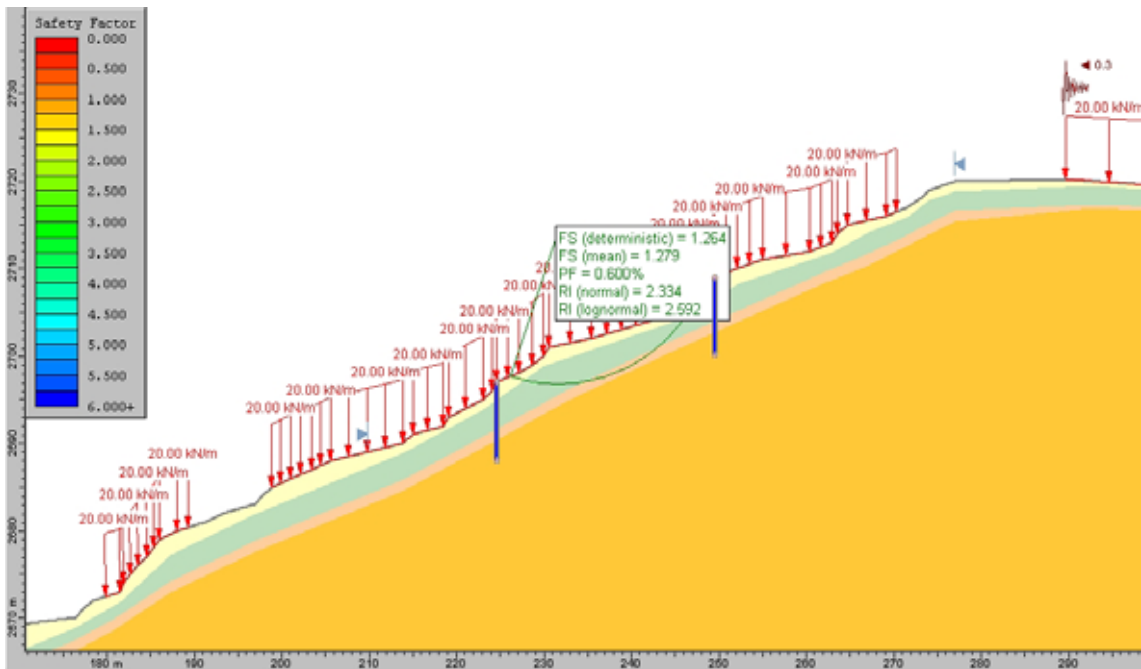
Modelo sección A-2 con obras de drenaje y pilotes
